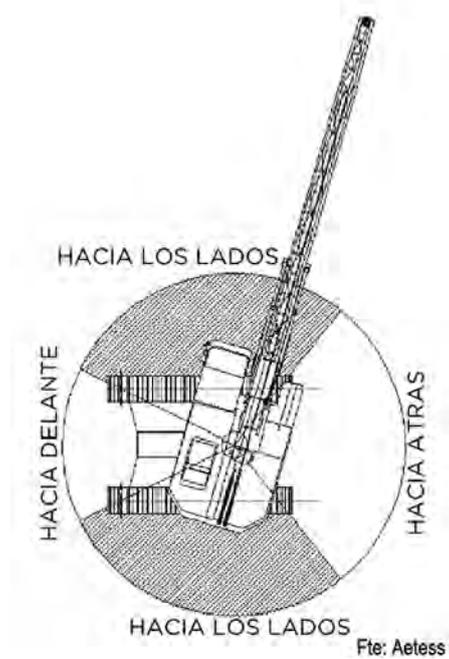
Grúas de cadenas con el centro de giro desplazado.
